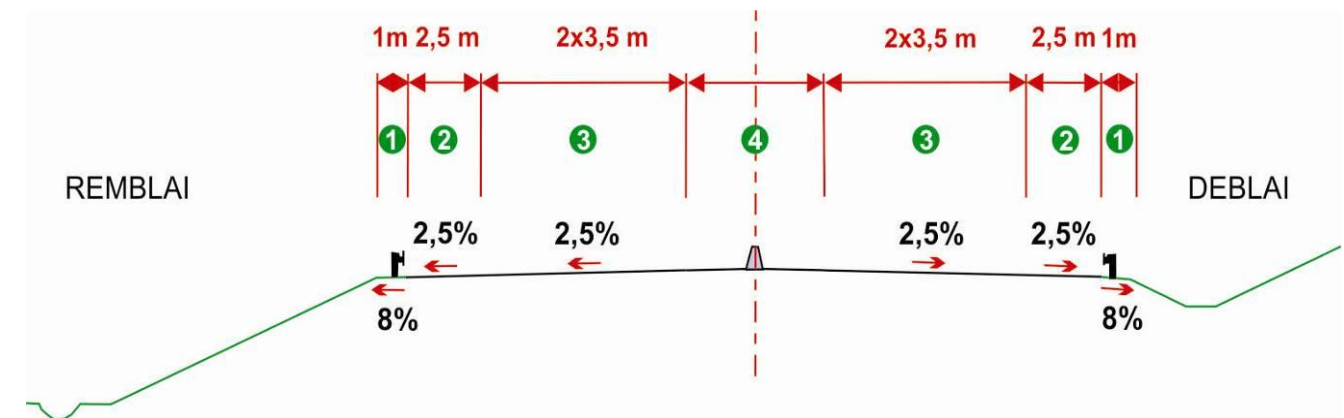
Profil en travers type de l'autoroute A71 au droit de la section à aménager
